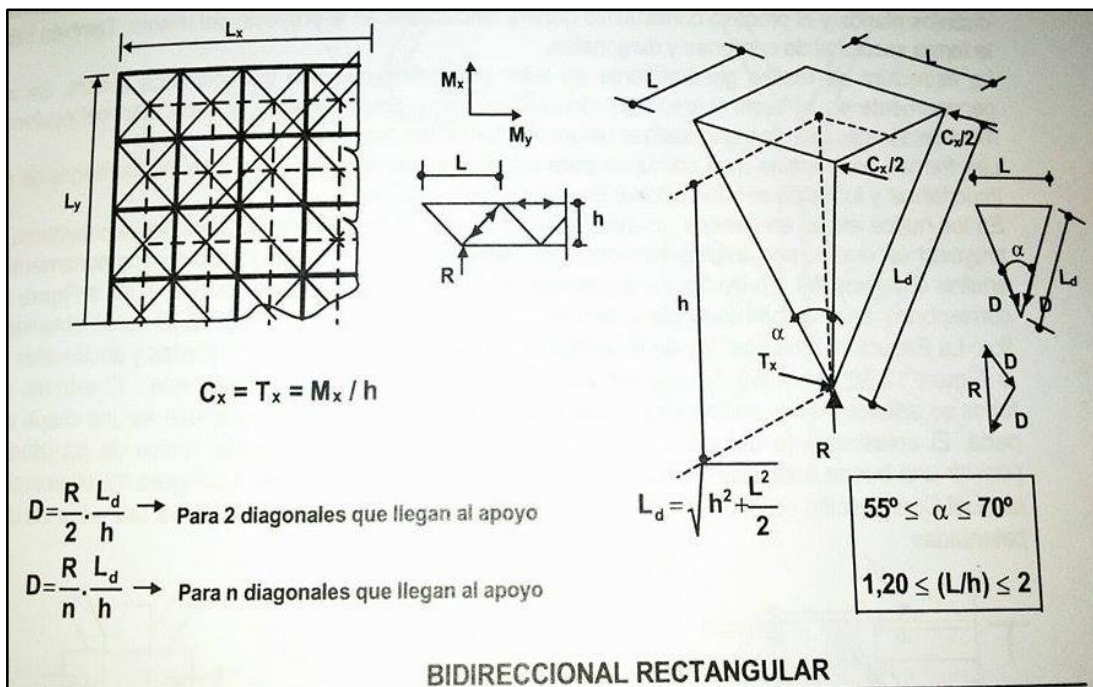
Criterios de predimensionado. Fuente: Estructuras metálicas. Ing. Troglia
